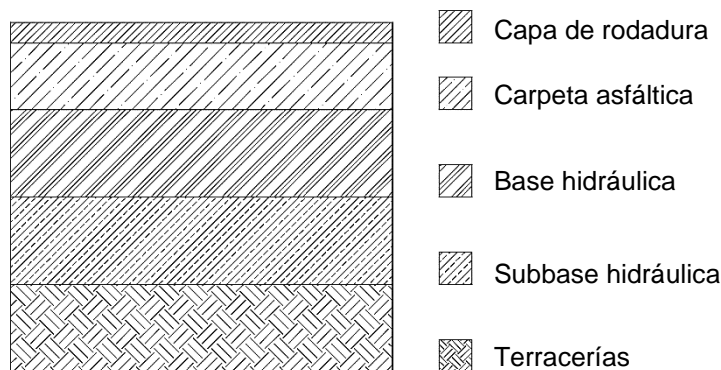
Sección transversal de un pavimento asfáltico convencional
